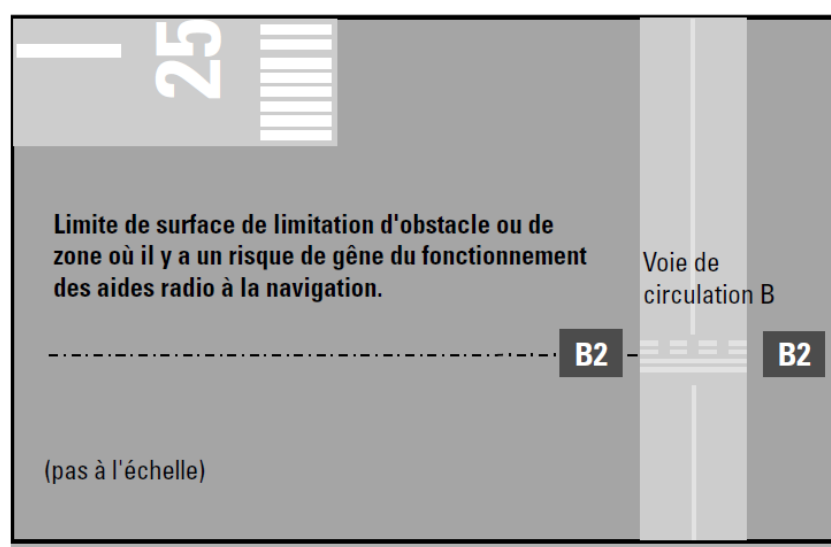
Exemple d'un point d'attente avant piste défini au § I.5.1.3.2.1 cas c)
